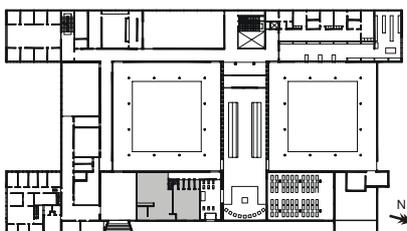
Localização atual das áreas de sacristia. Primeiro Pavimento. (Desenho da autora).
